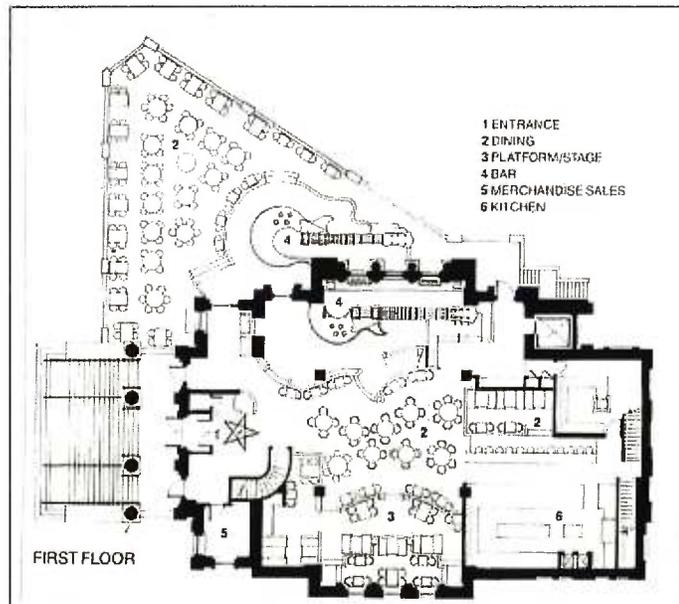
Hard Rock Cafe (Dallas). Plan du rez-de chaussée.
